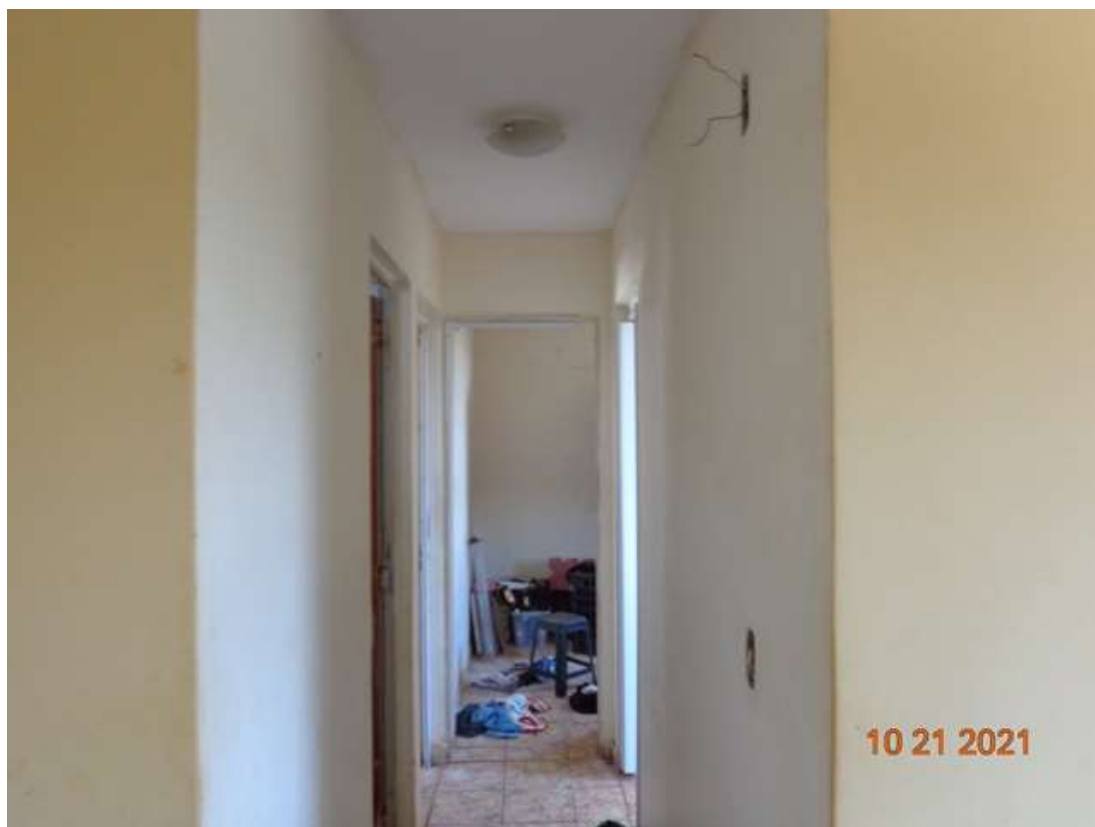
Corredor de acesso ao banheiro e dormitórios (3).
